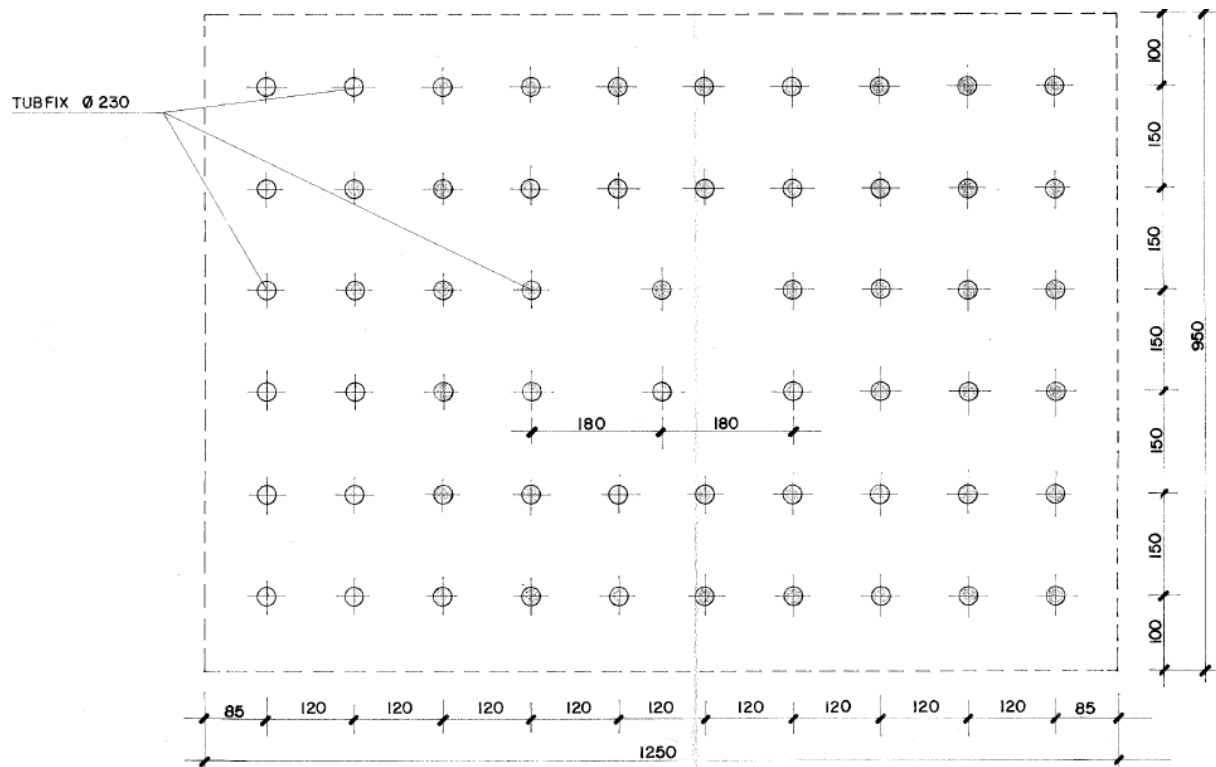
Pianta pila P16 su fondazione diretta con n°58 micropali
